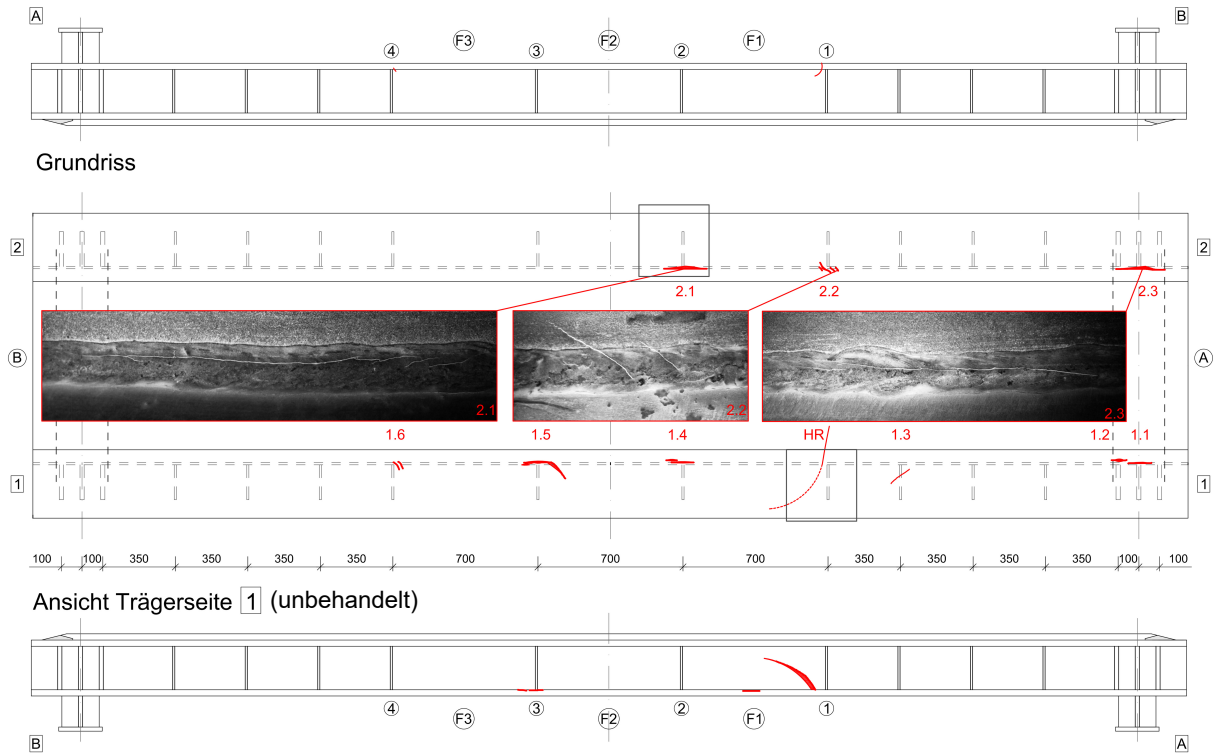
Rissbild: Draufsicht und Längsansicht Trogbrückenversuch T1
